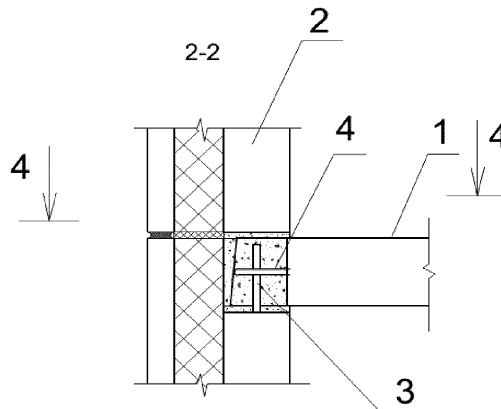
Фрагмент монтажной схемы, сечение 2-2: 1 – плиты перекрытия; 2 – стены; 3 – анкер из стены; 4 – арматурные выпуски из плит перекрытий
